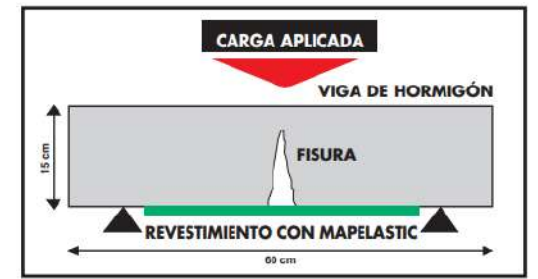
Protección con Mapelastic de una fisura en el intradós de una viga de hormigón sometida a una tensión por flexión
